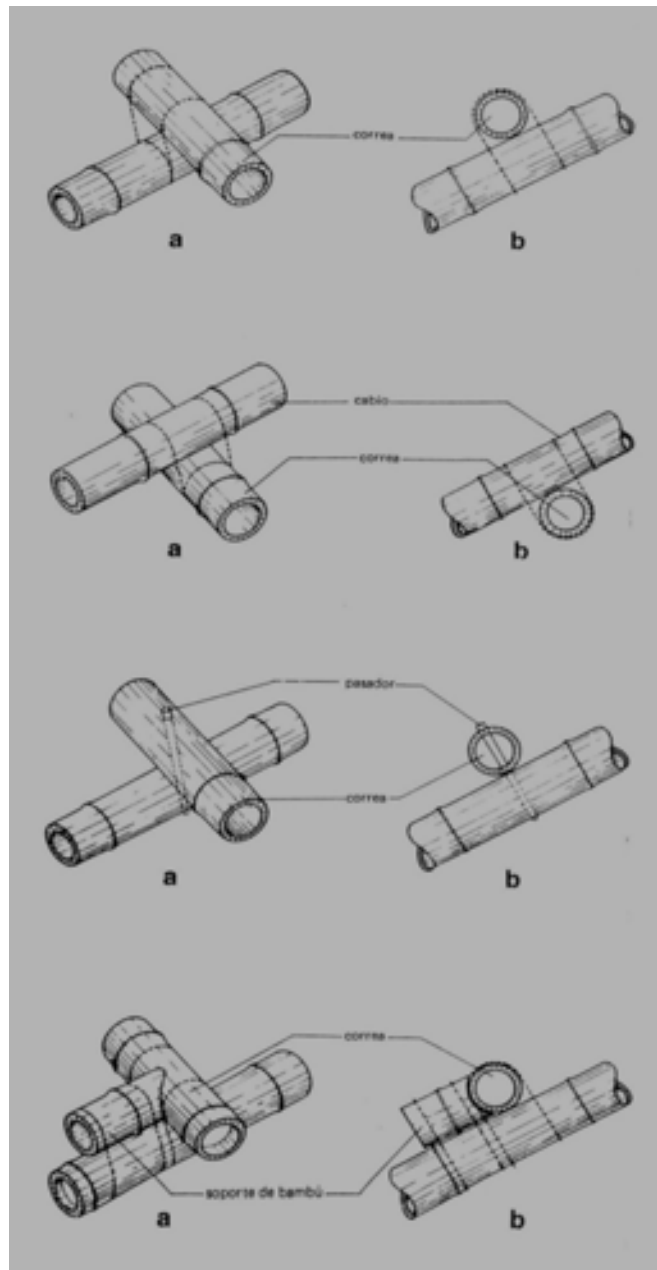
Amarrações entre caibros e ripas do telhado.
